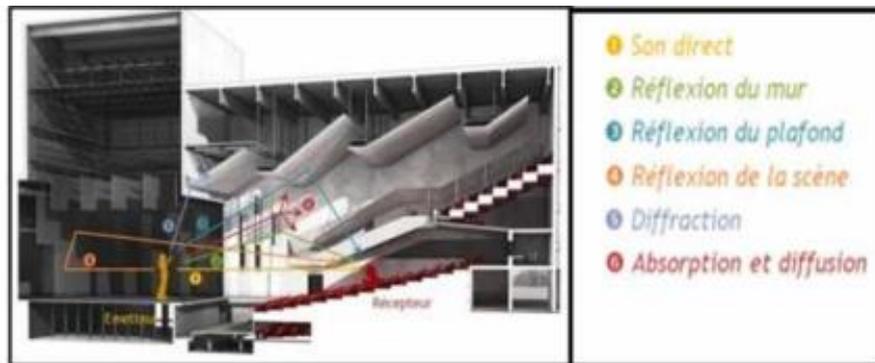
Coupe longitudinale dans une salle cinéma avec un plafond en escalier
